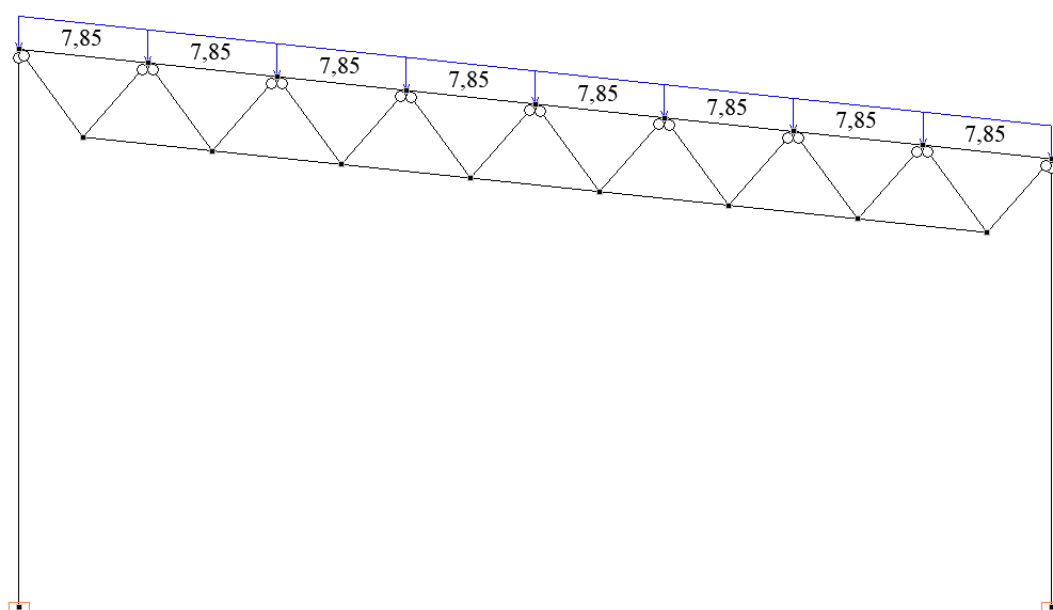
Схема загрузки рамы снеговой нагрузкой
